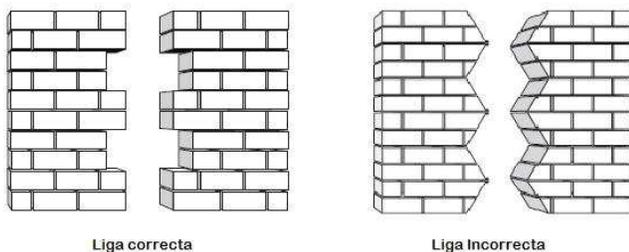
Liga muro – castillo (MTCHA 2008)
